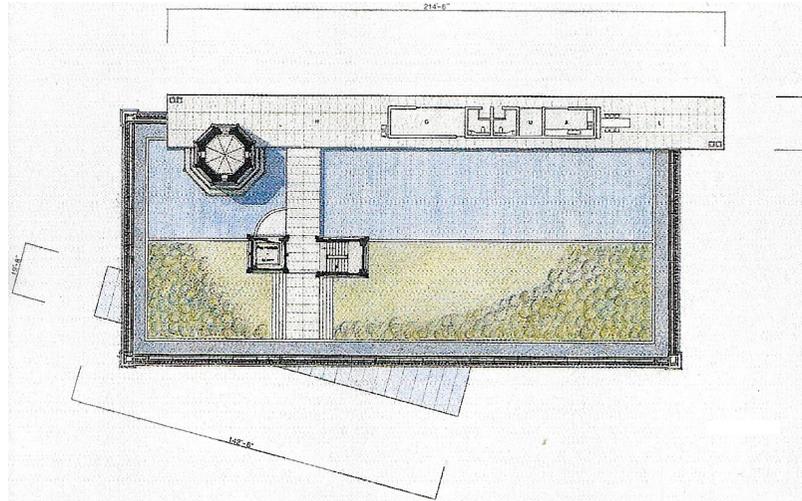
Planta cubierta del edificio anterior con la intervención del arquitecto japonés.
